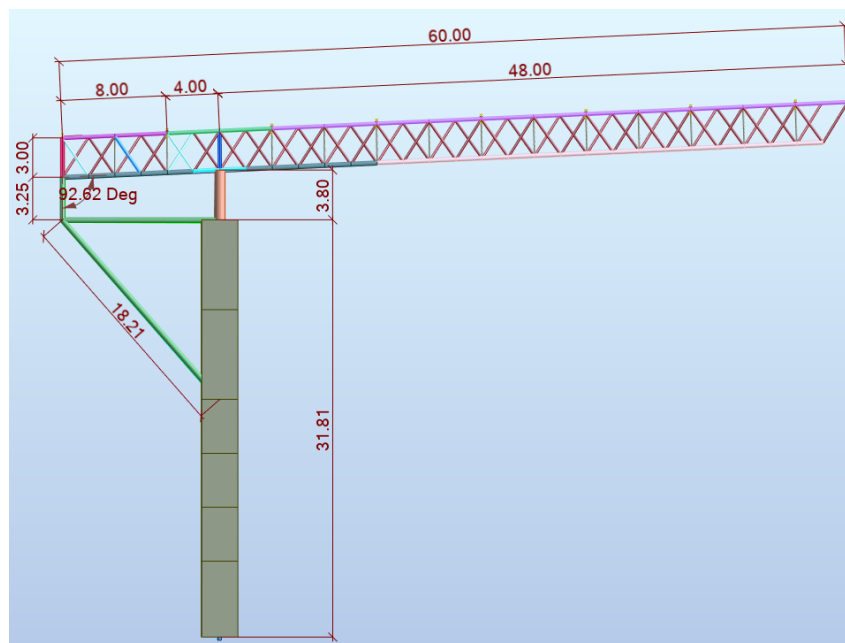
Longueurs de la toiture (Vue latérale)
